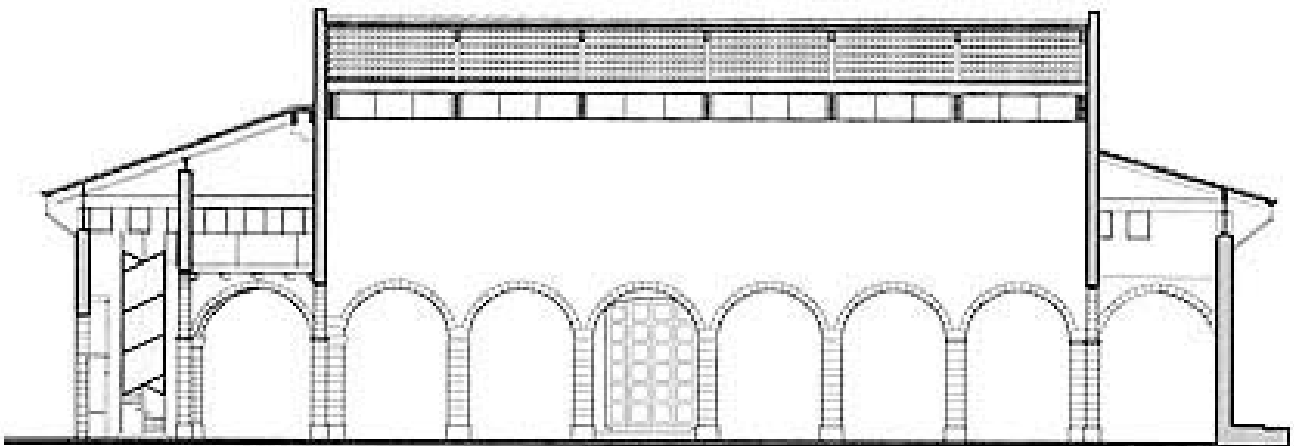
Sección longitudinal. Fuente Web: ViA arquitectura
